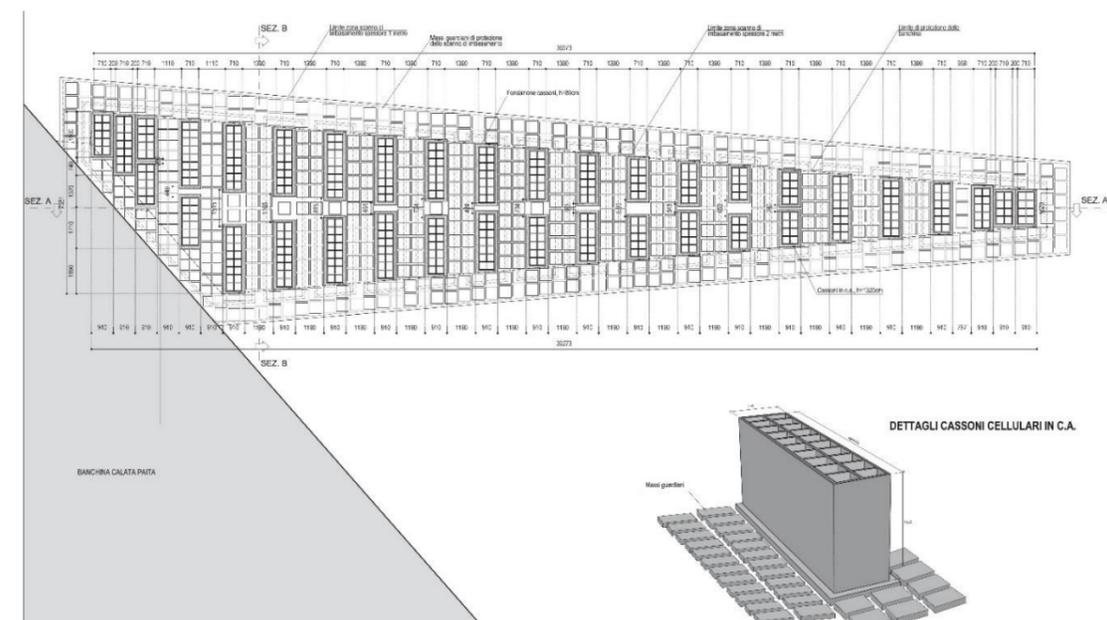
PIANTE DISPOSIZIONE CASSONI E VISTA DI DETTAGLIO
